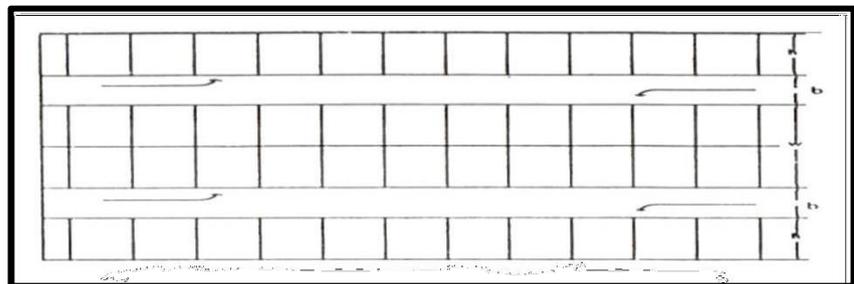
Parkir Tegak Sudut yang Berhadapan
